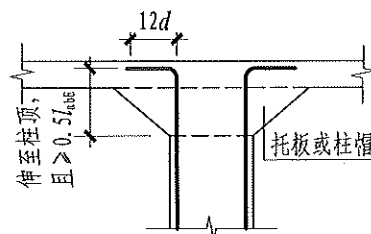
无梁楼盖中柱柱顶纵向钢筋构造
